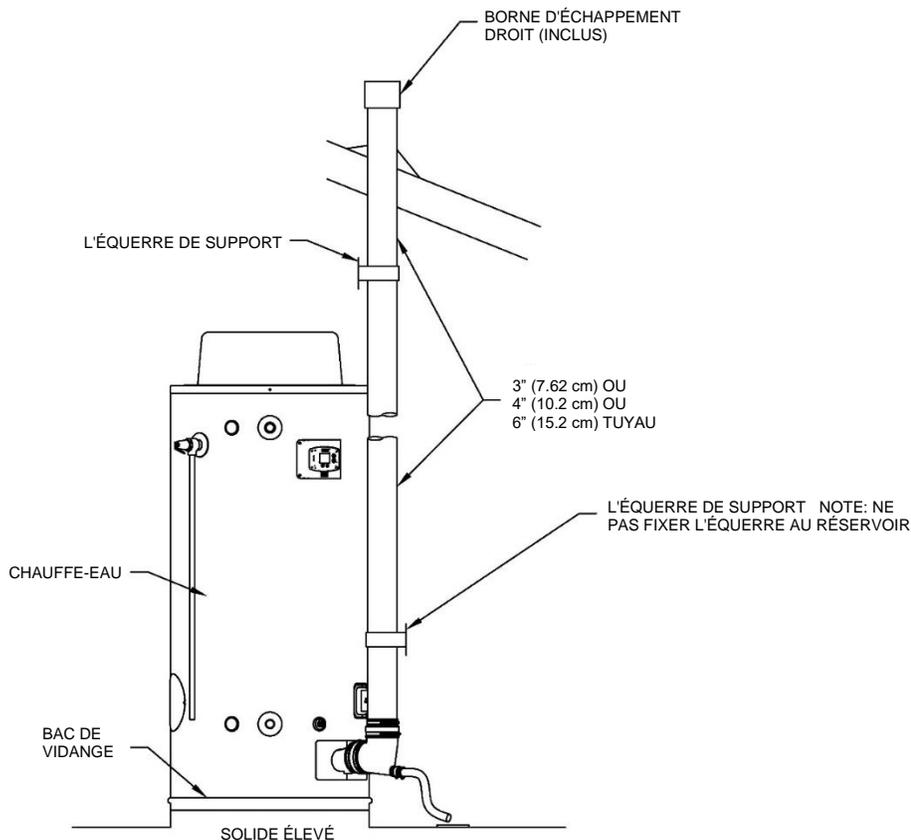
Installation d'un système vertical typique de ventilation électrique
